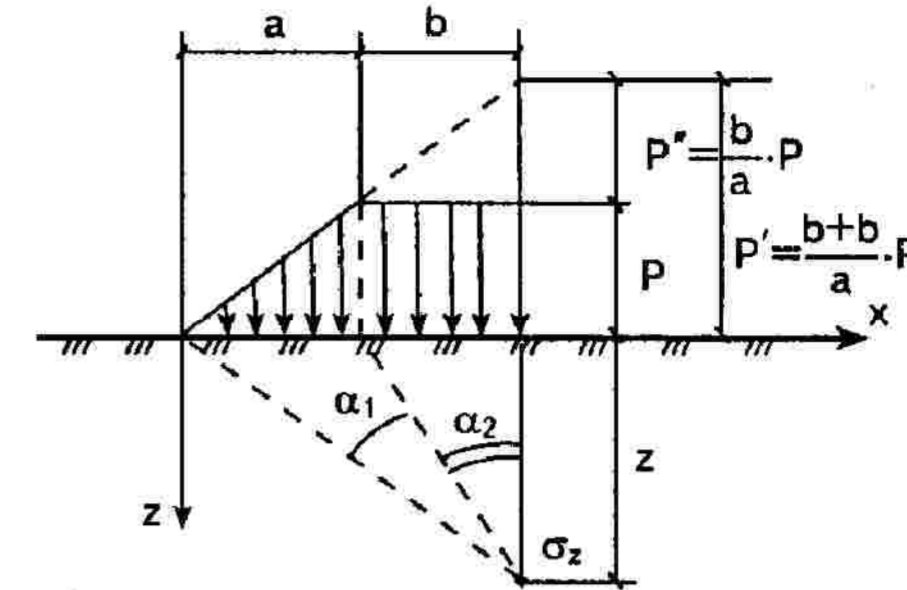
Расчетная схема к определению вертикального напряжения от трапецидальной нагрузки
